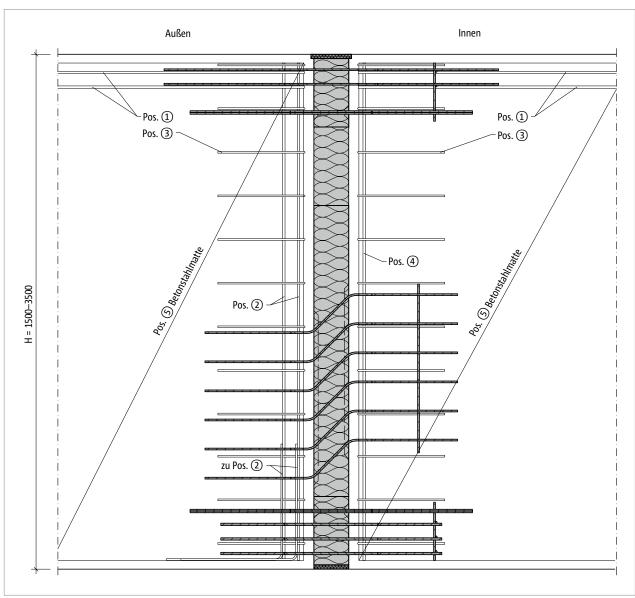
Schöck Isokorb® XT Typ W: Bauseitige Bewehrung; Schnitt
